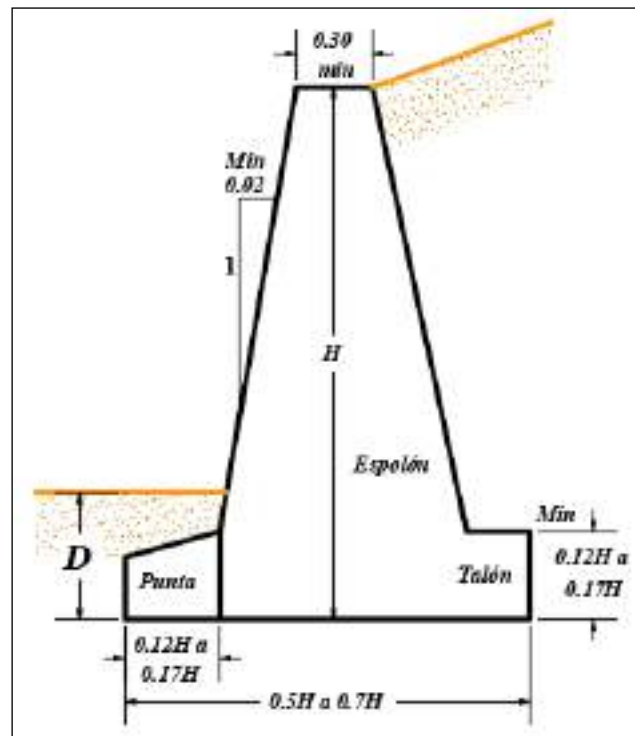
Predimensionamiento de muro de gravedad (fuente: Braja, 2013)
